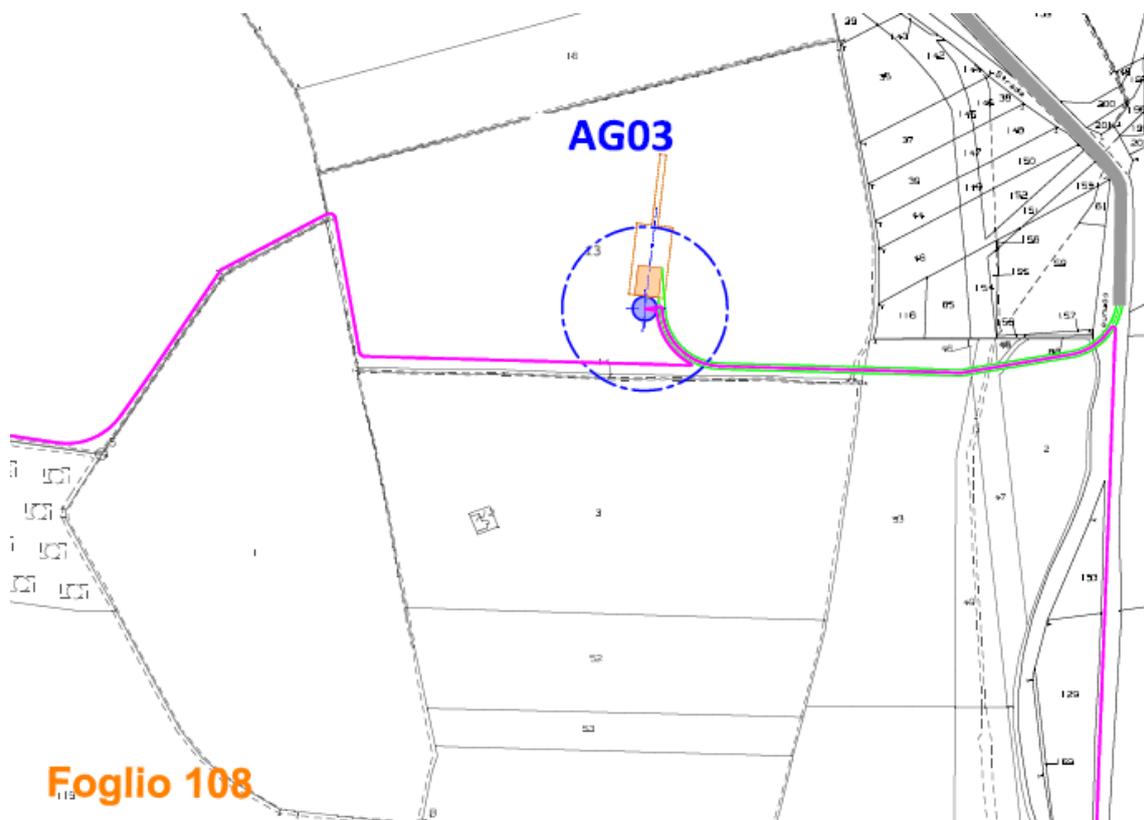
Estratto elaborato SPN_2.6C - Planimetria Linea Elettrica su Catastale
